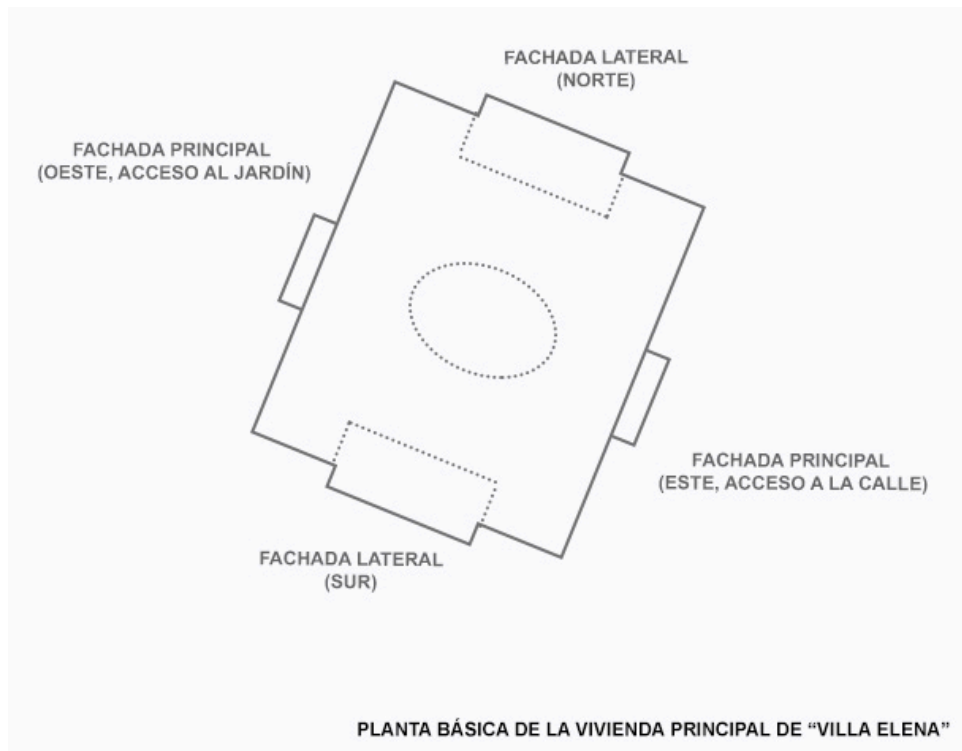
Planta de Villa Elena. Fuente: Elaboración propia.
